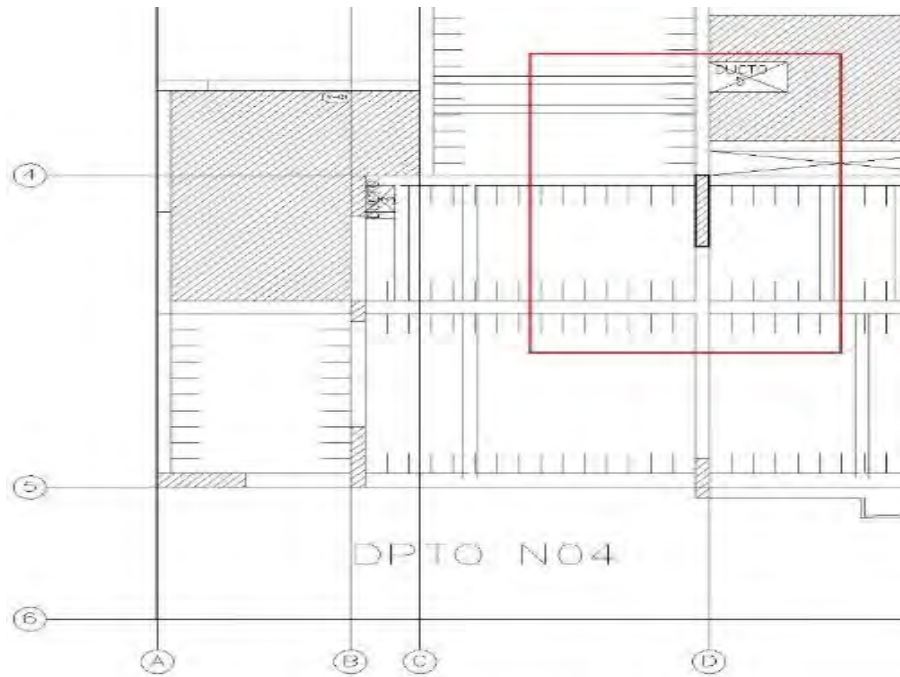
Muro de corte elegido para el metrado de cargas
